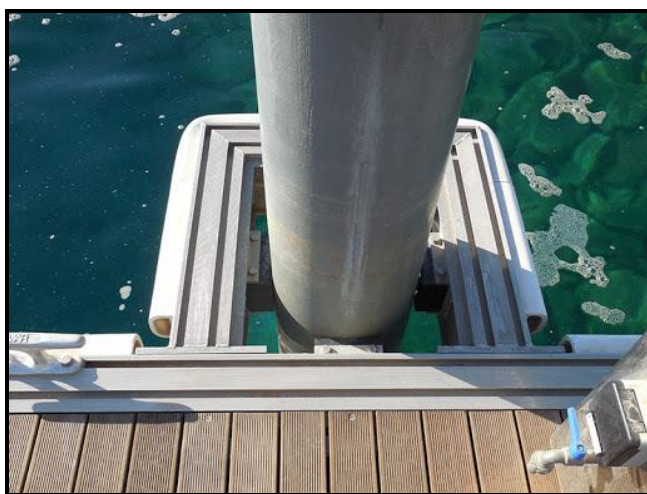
e 4.6.2.2: pontile galleggiante con palo in acciaio
